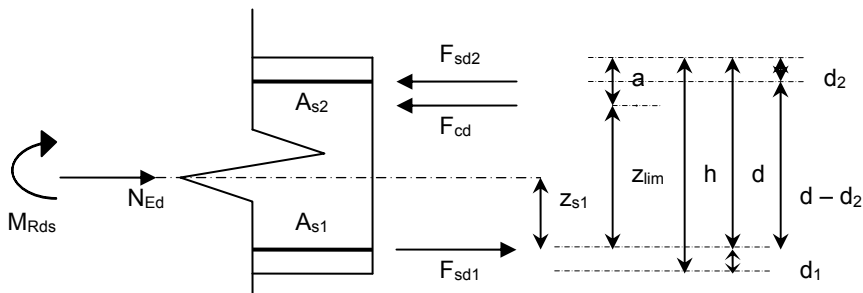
Rechteckquerschnitt mit Druckbewehrung unter einachsiger Biegung mit Längskraft
